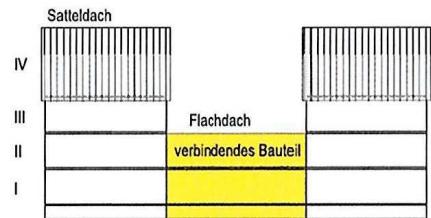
Erläuterungsskizze zur abweichenden Bauweise
